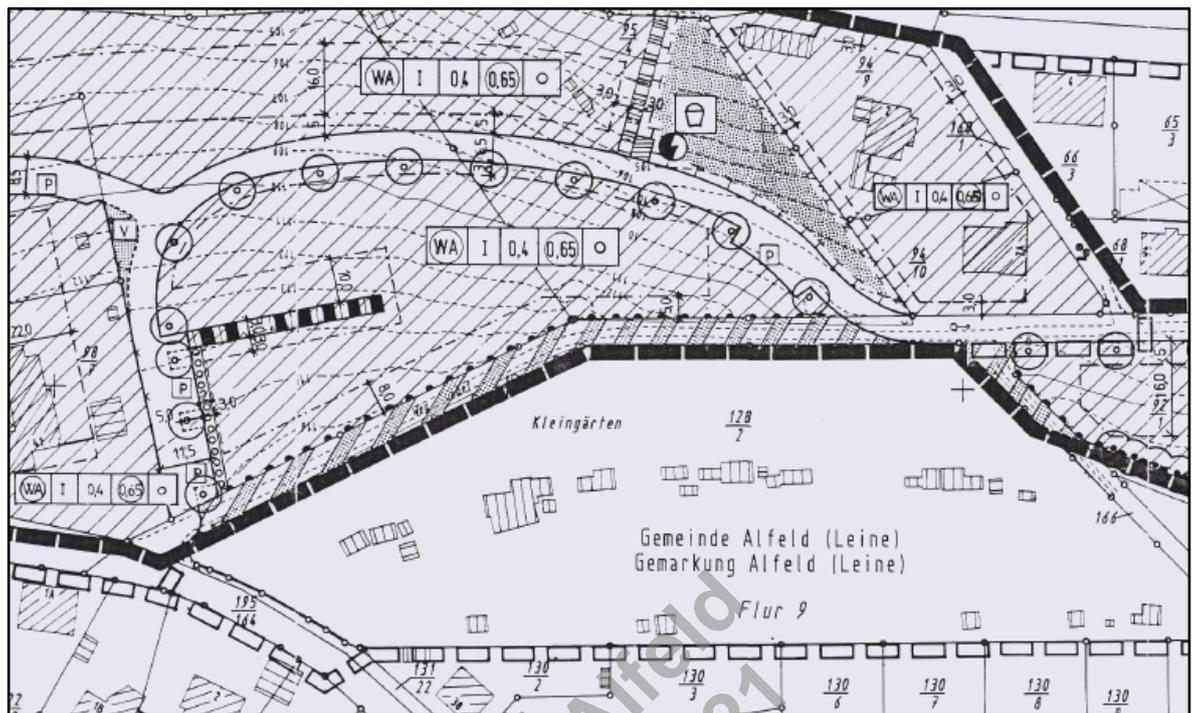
Ausschnitt B-Plan Nr. 43 „Im Wambeck“ (ohne Maßstab)
